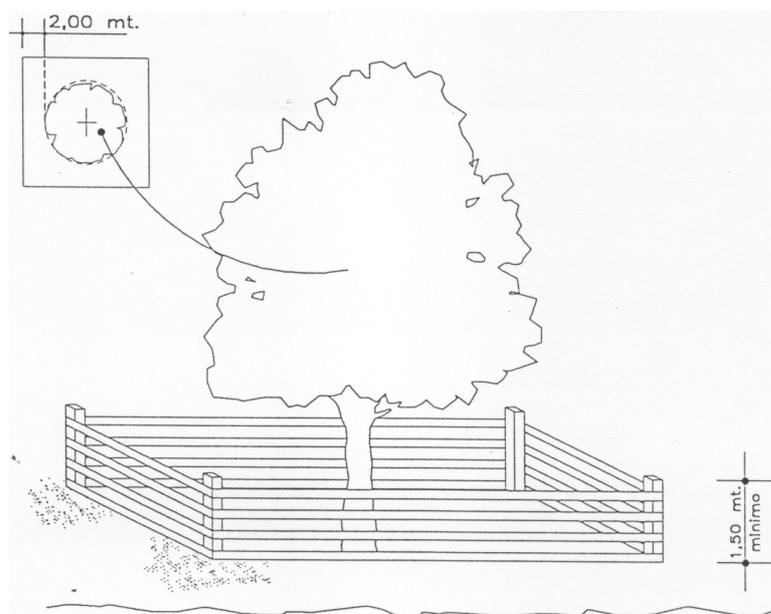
Protezione dell'albero attraverso la delimitazione dell'area minima di rispetto in aree parco
